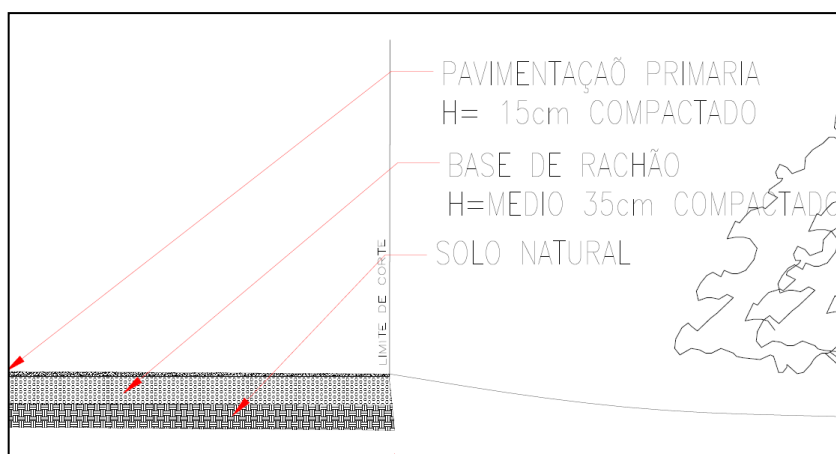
Detalhe da pavimentação prevista no projeto arquitetônico.
